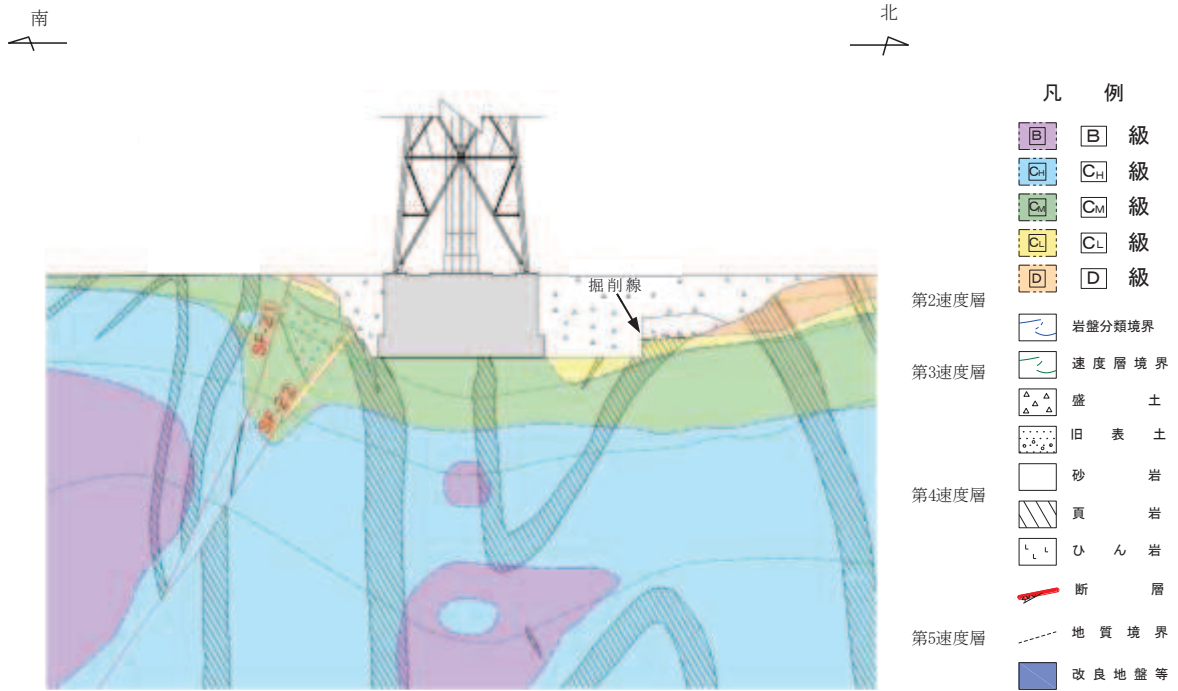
排気筒の地質断面図 (⑤-⑤断面)
